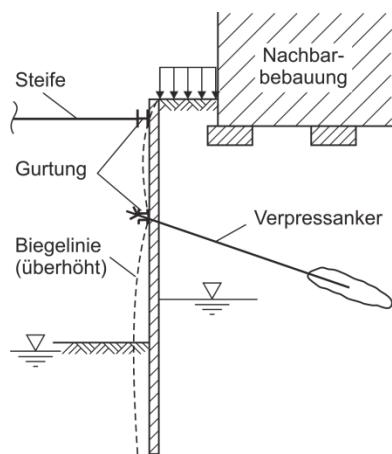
Schematisches Beispiel für eine Baugrubensituation mit Nachbarbebauung
